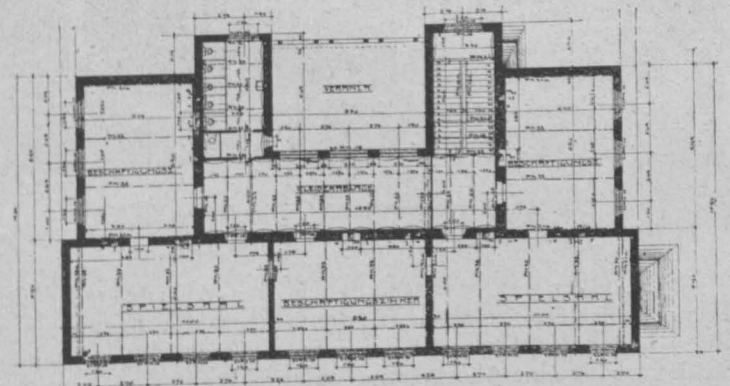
Grundriß des I. Stockes zu Abb. 35.
